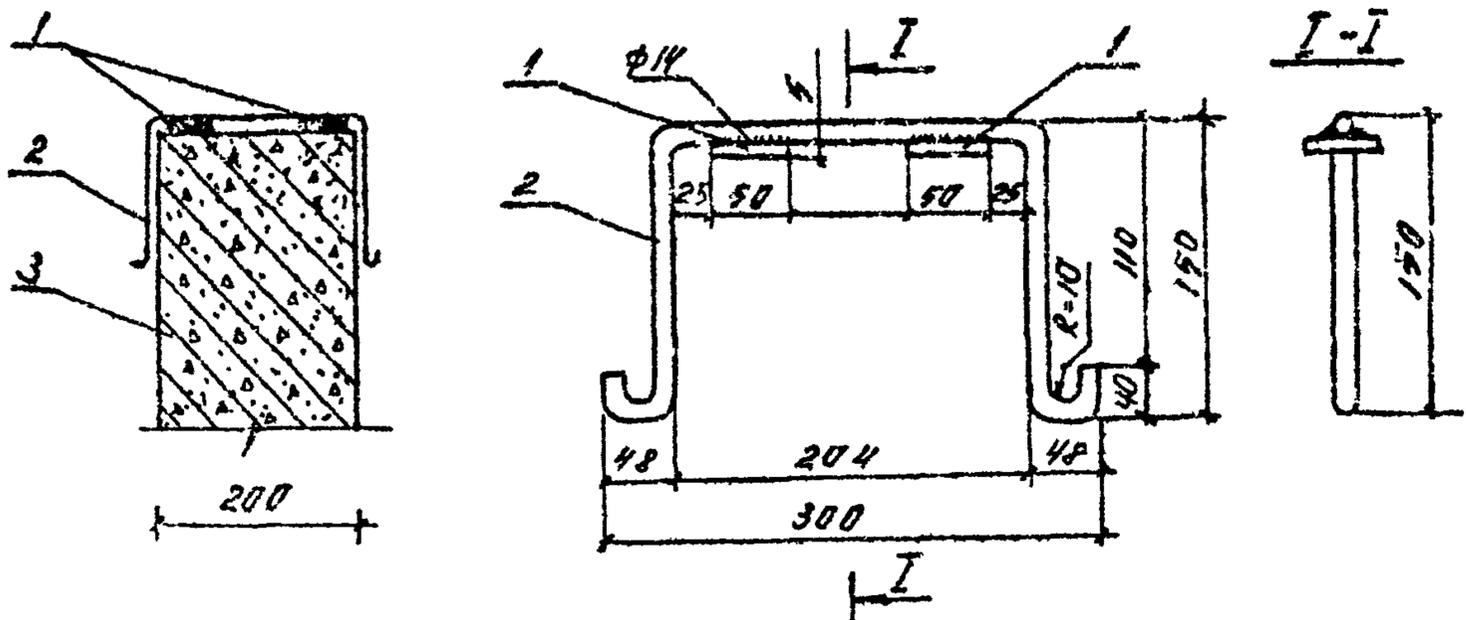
Хомут. Вариант по сборным железобетонным балкам перекрытия.
